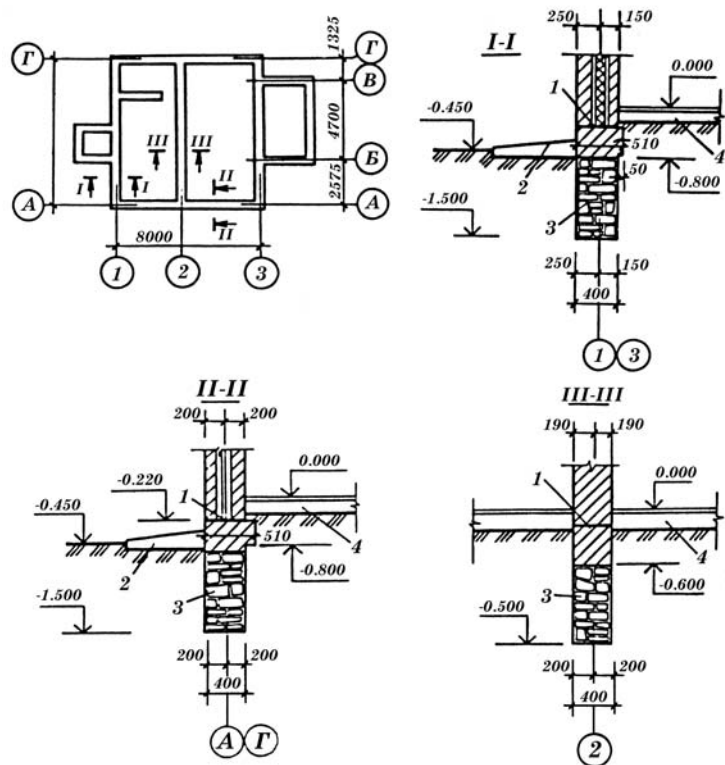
Пример заложения ленточного бутобетонного фундамента: 1 – гидроизоляция на отметке – 0,22; 2 – отмостка; 3 – фундамент; 4 – пол.
